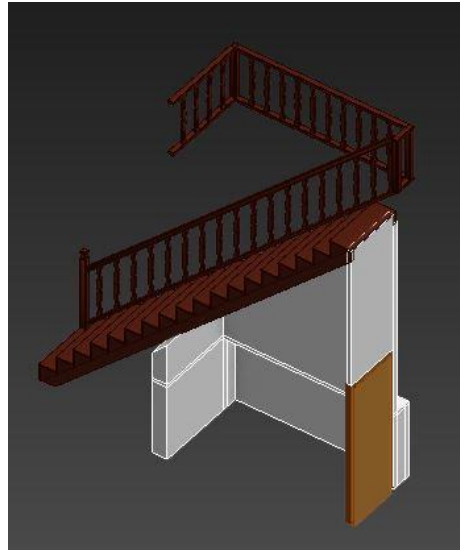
Vista del conjunto de la escalera de acceso a la planta segunda, incluyendo la barandilla y la estructura de soporte.
